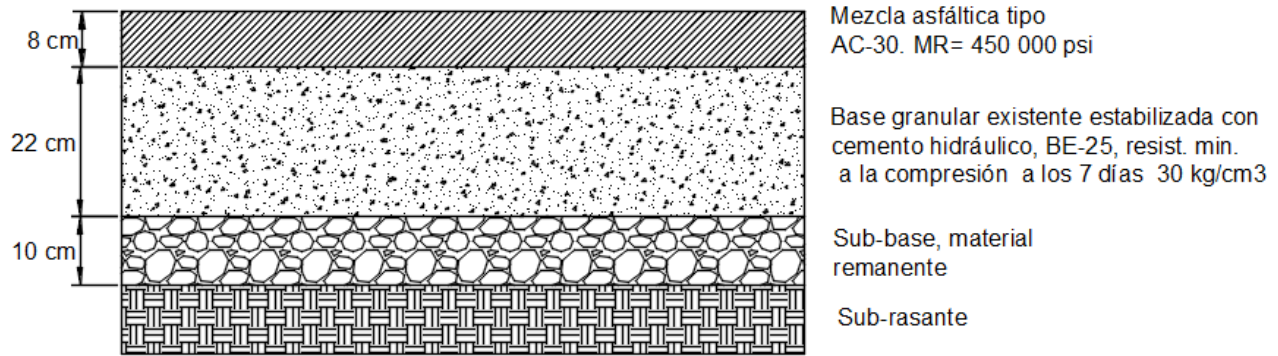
Perfil de la estructura de pavimento propuesta para el TH=39, P#2.
